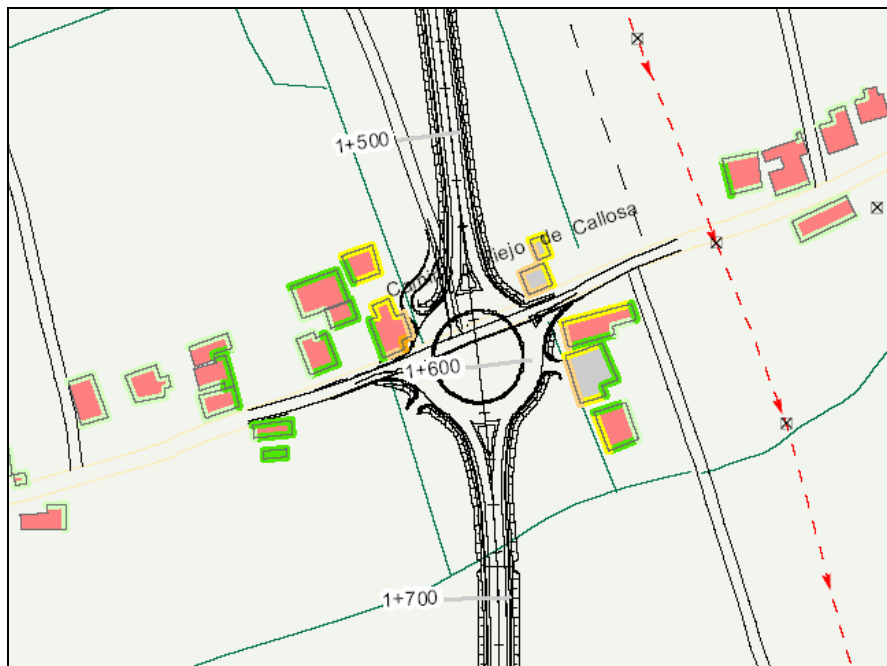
Niveles de Ln en Fachada en la zona del enlace con CV-91.
